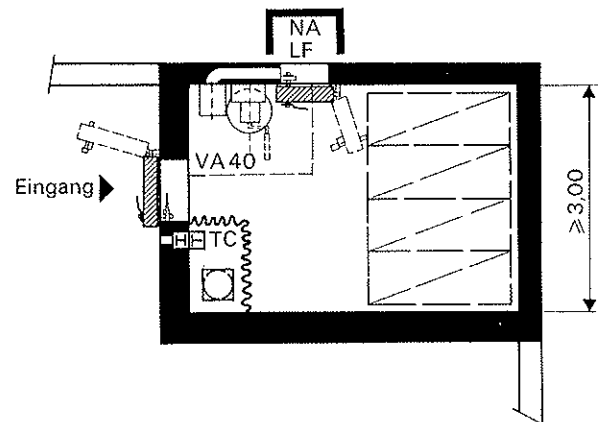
Grundrissform für 8 Schutzplätze (Bodenfläche $\geq 9 \text{ m}^2$)
